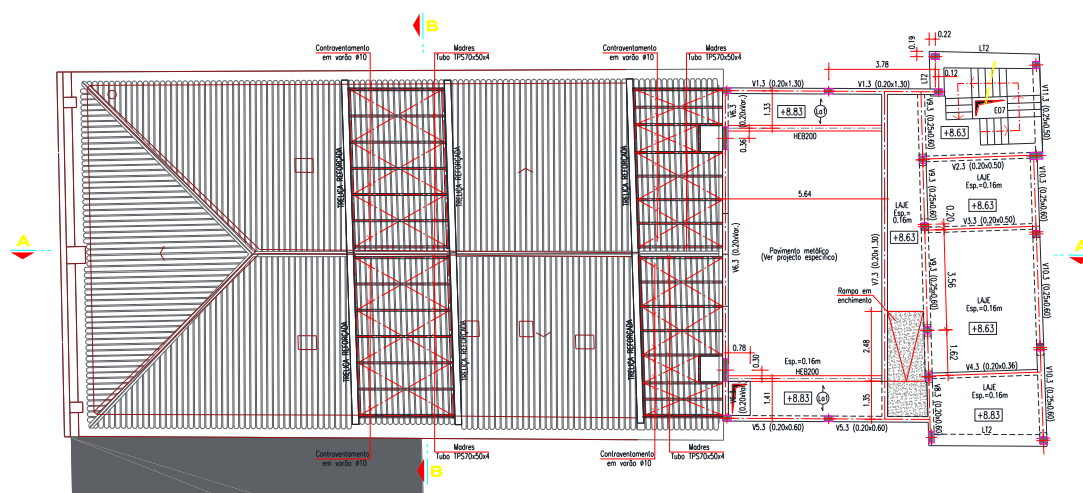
Reforço da cobertura de madeira da zona da entrada e da zona da plateia (planta, s/ escala)
